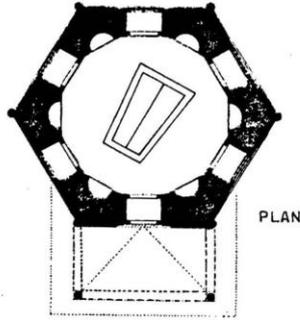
مسقط أفقي لتربة صوفولر في مرزيفون،
